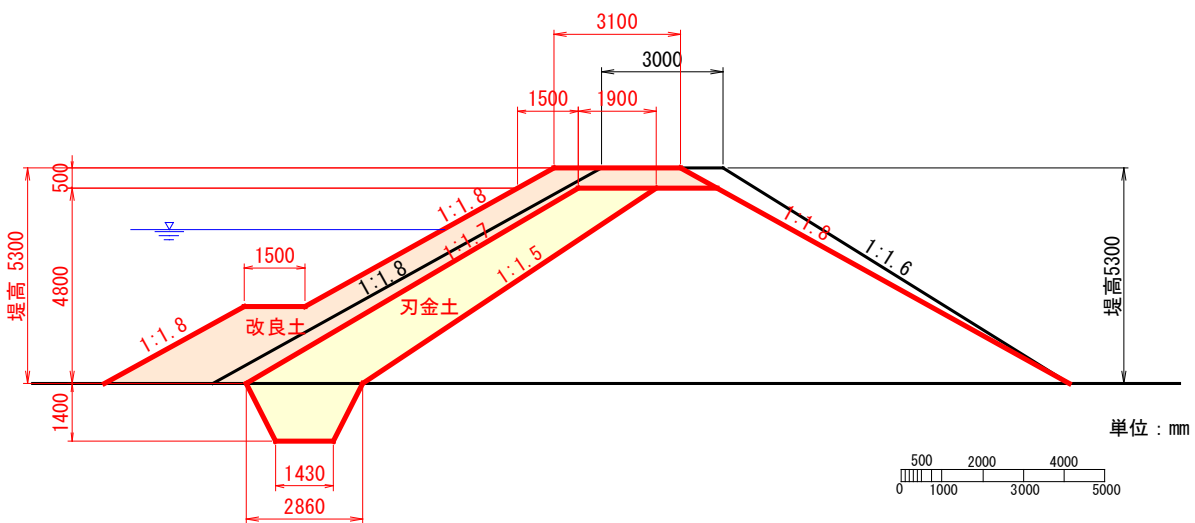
施工コスト算定用計画堤体断面（堤体盛土改良工法）-1（H=5.3 m）
